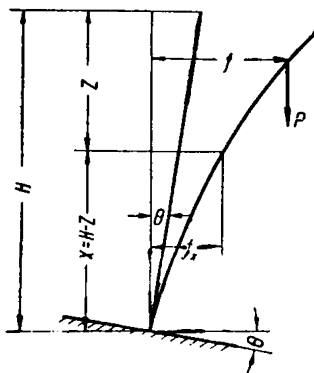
Расчетная схема прогиба трубы от действия ветровой нагрузки с учетом крена фундамента
